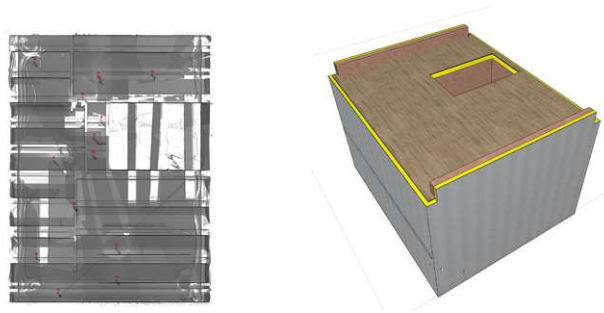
Spezifischer Deckenschnitt zur Visualisierung der Deckenkontur (links) und die fertig modellierte Decke mit Deckendurchbruch (rechts)
